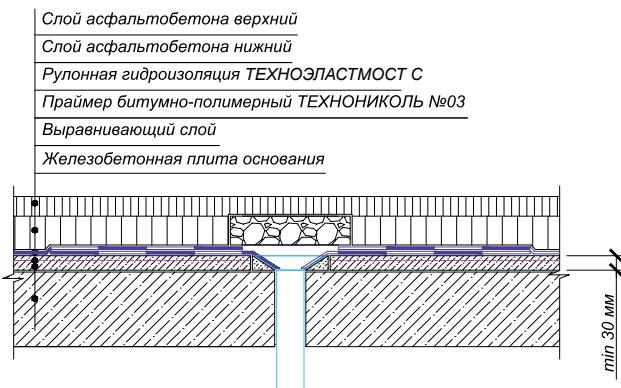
Сопряжение гидроизоляции с дренажной трубкой.
